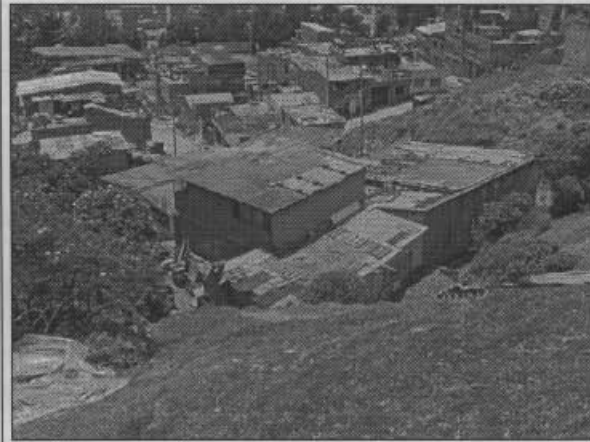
Vivienda ubicada en la parte baja de la ladera; Carrera 1 este No. 46A - 02 interior 3..
